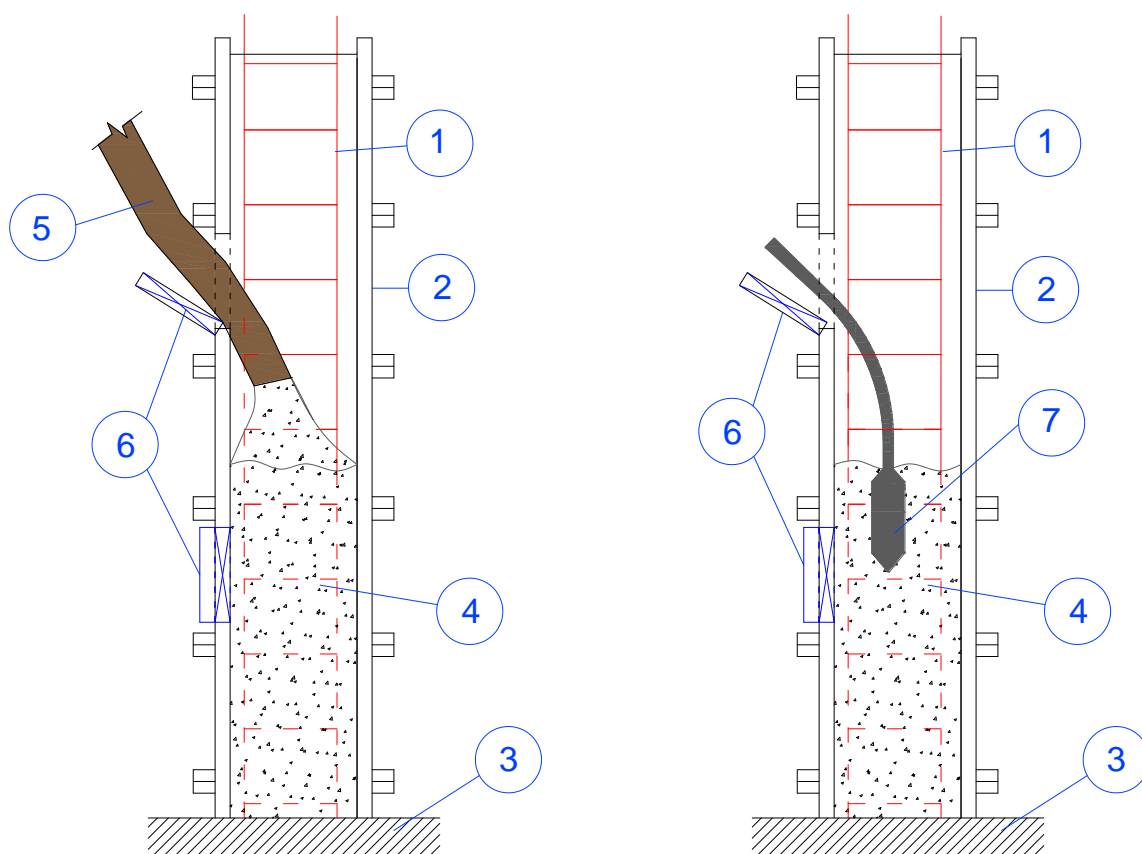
Схема подачи и уплотнения бетонной смеси через технологические окна при бетонировании стен ЗЛА
